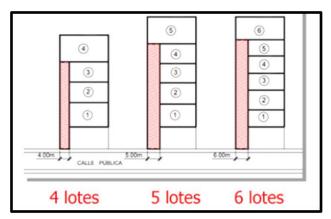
Ancho vías, en fraccionamiento de 4 a 6 lotes.
